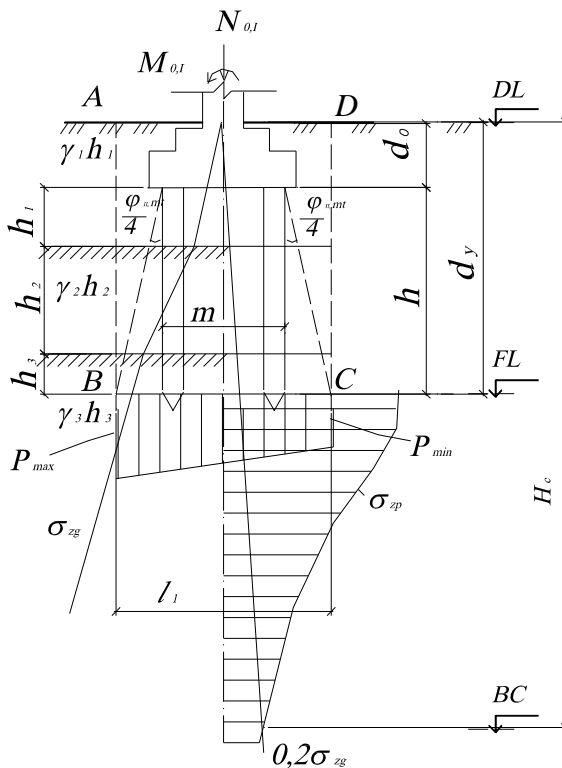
Схема к расчету осадки для свайного фундамента методом послойного суммирования
